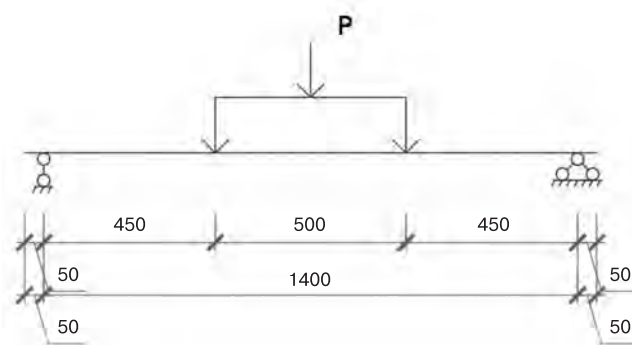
Схема испытаний партий образцов с шифрами 1.1-1; 1.1-3; 1.2-1 и 1.2-3
